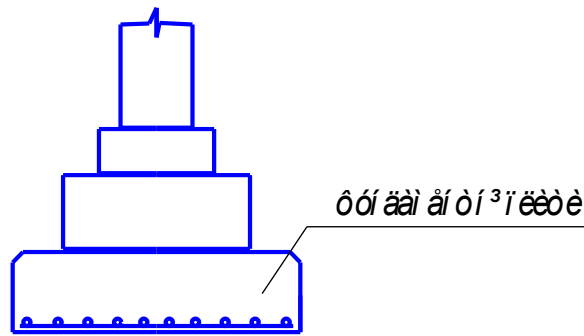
Схема фундаменту у вигляді суцільної залізобетонної плити.
